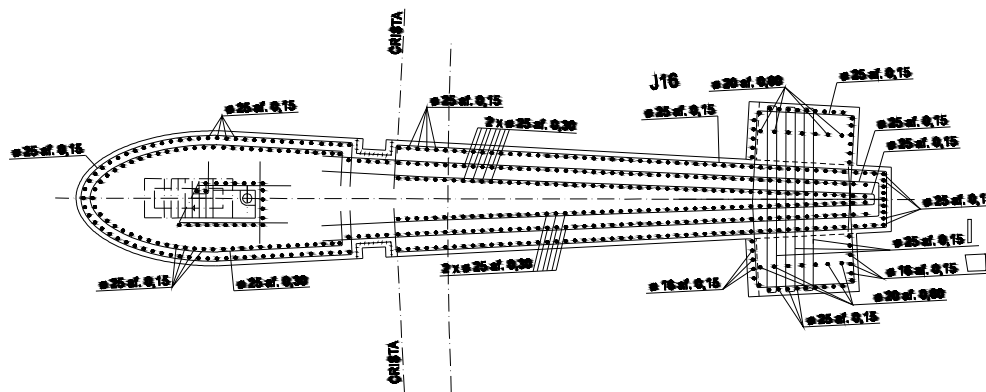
Pilar PE3 - Armaduras -Planta
